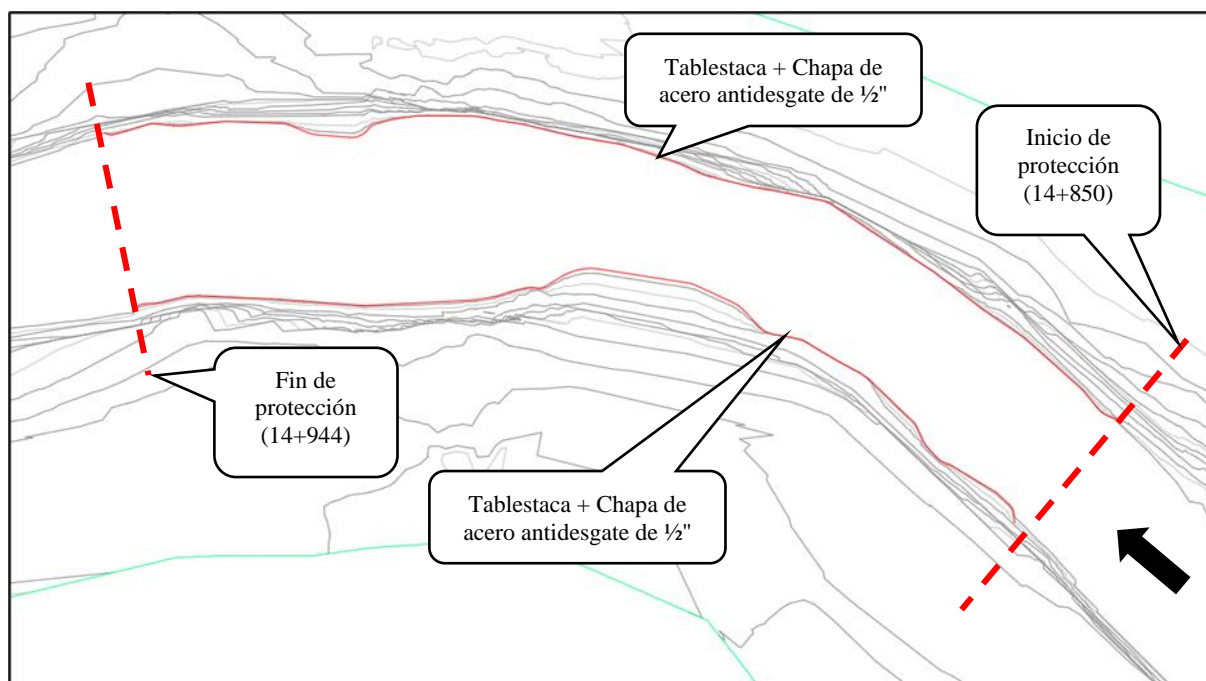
Defensa proyectada – Planta general. Fuente: Elaboración propia.
